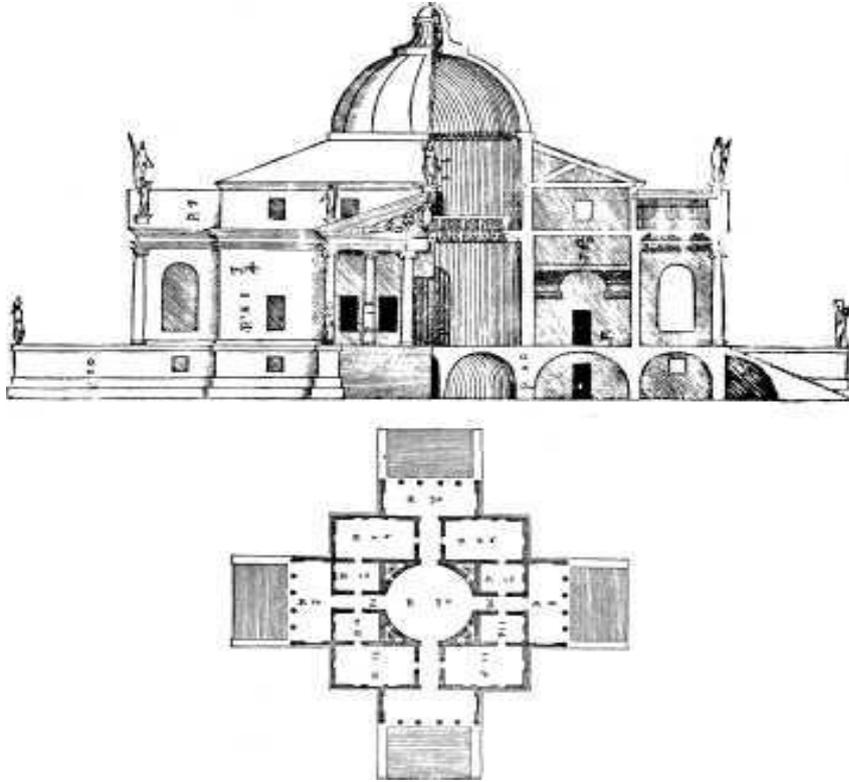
Villa Capra "La Rotonda" 1559-1560. Fachada y sección integrados y Planta. Andrea Palladio
